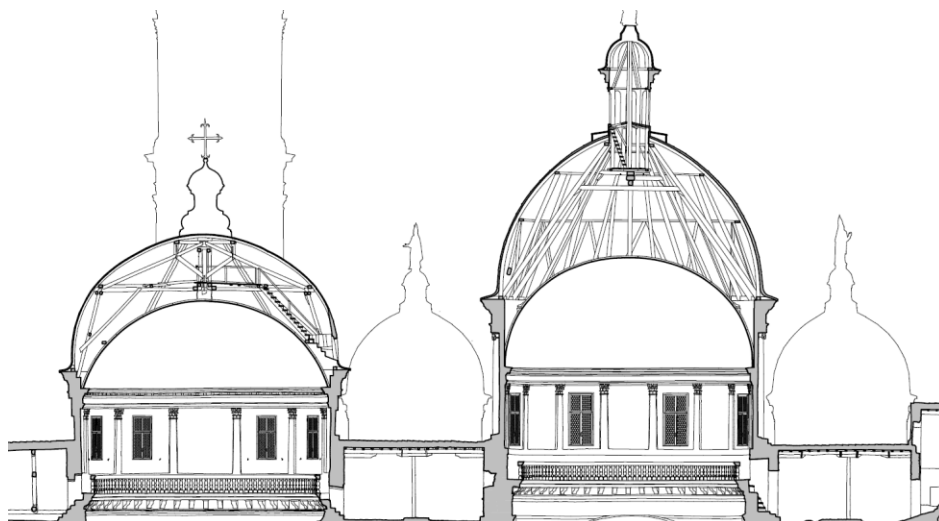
Dettaglio delle cupole tratto dalla sezione longitudinale dell'abbazia (Pfister, 2022).
